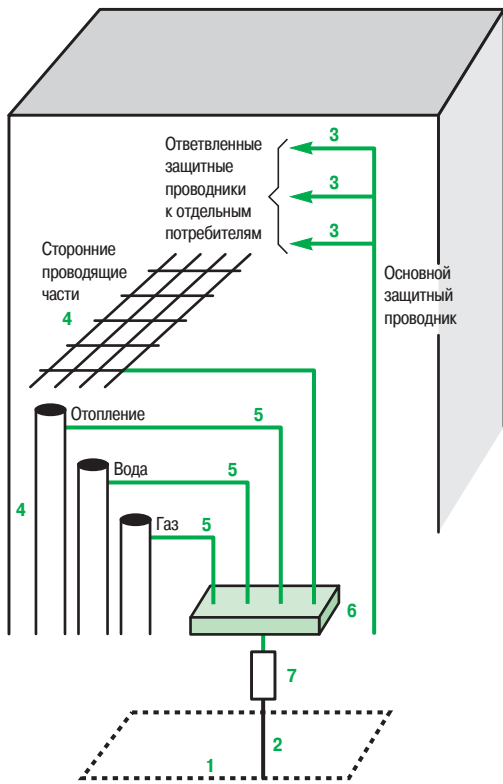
Пример жилого здания, в котором ГЗШ (6) обеспечивает основное эквипотенциальное соединение; съемная перемычка (7) обеспечивает проверку сопротивления заземляющего электрода
